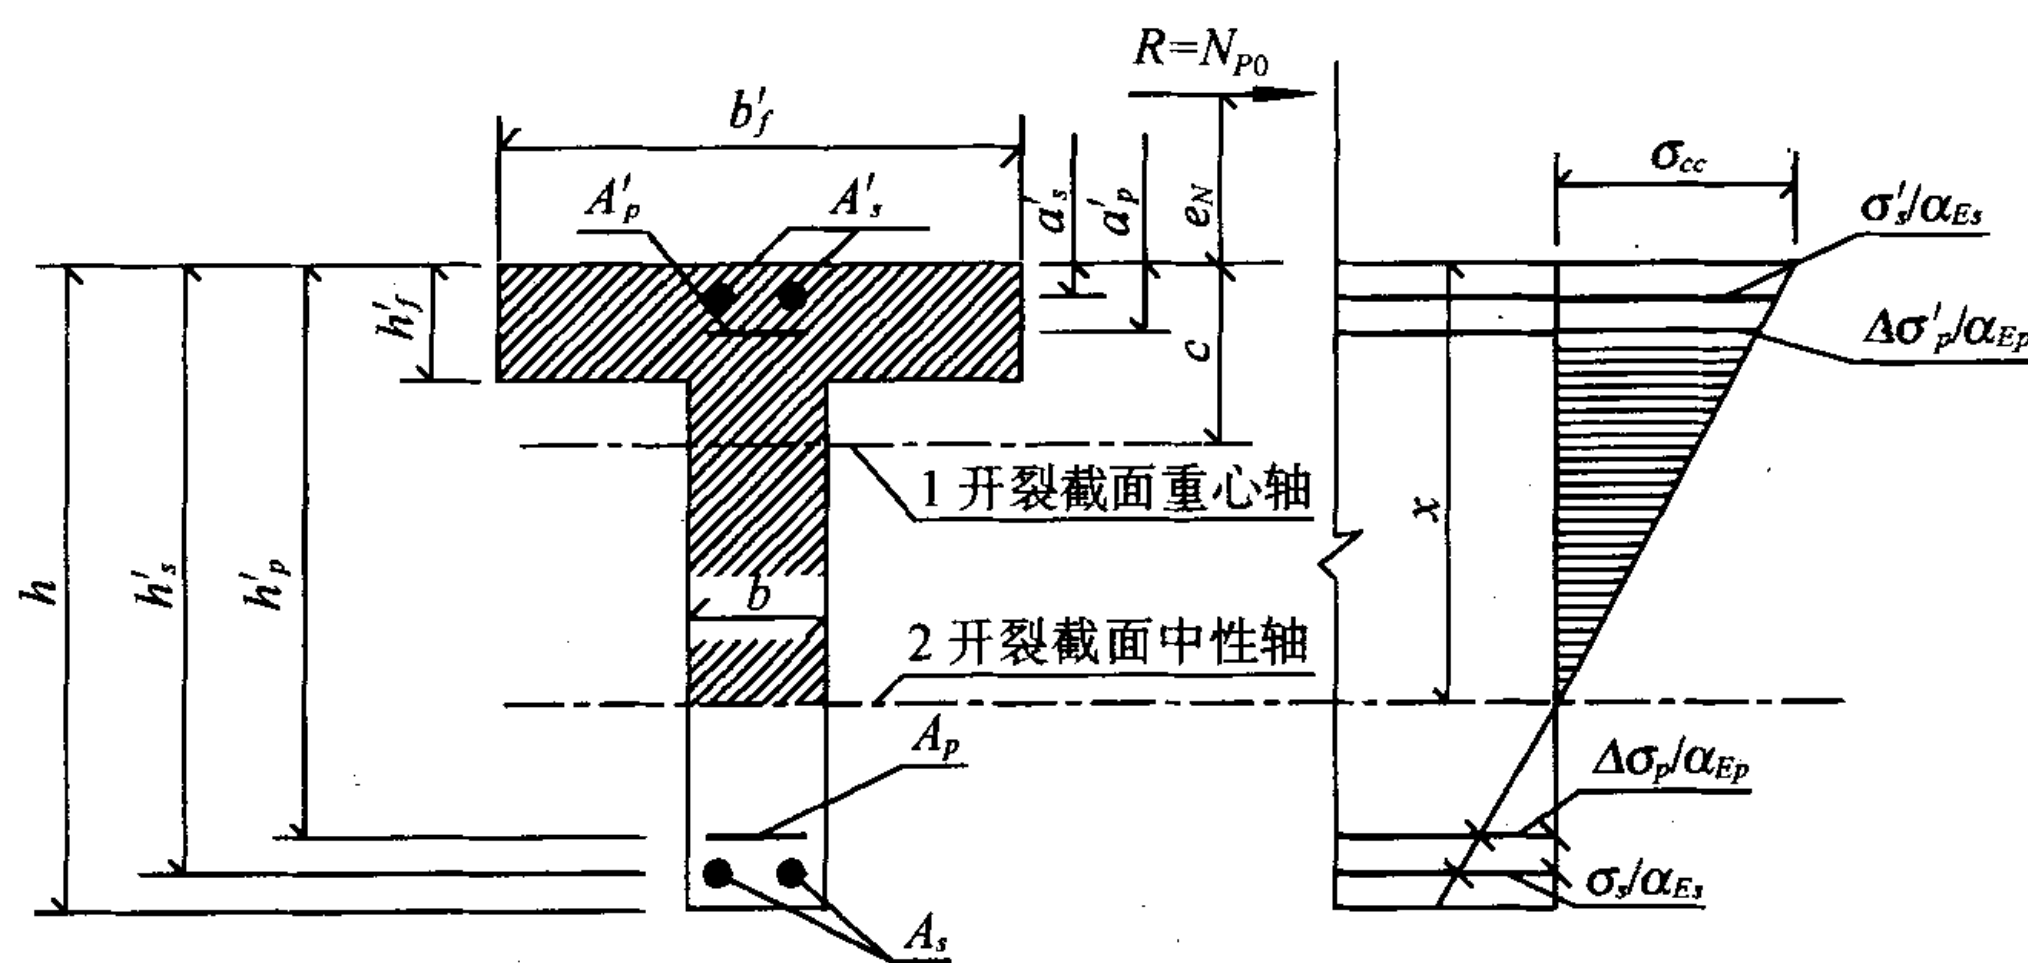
开裂后的部分预应力混凝土受弯构件截面应力计算图式
